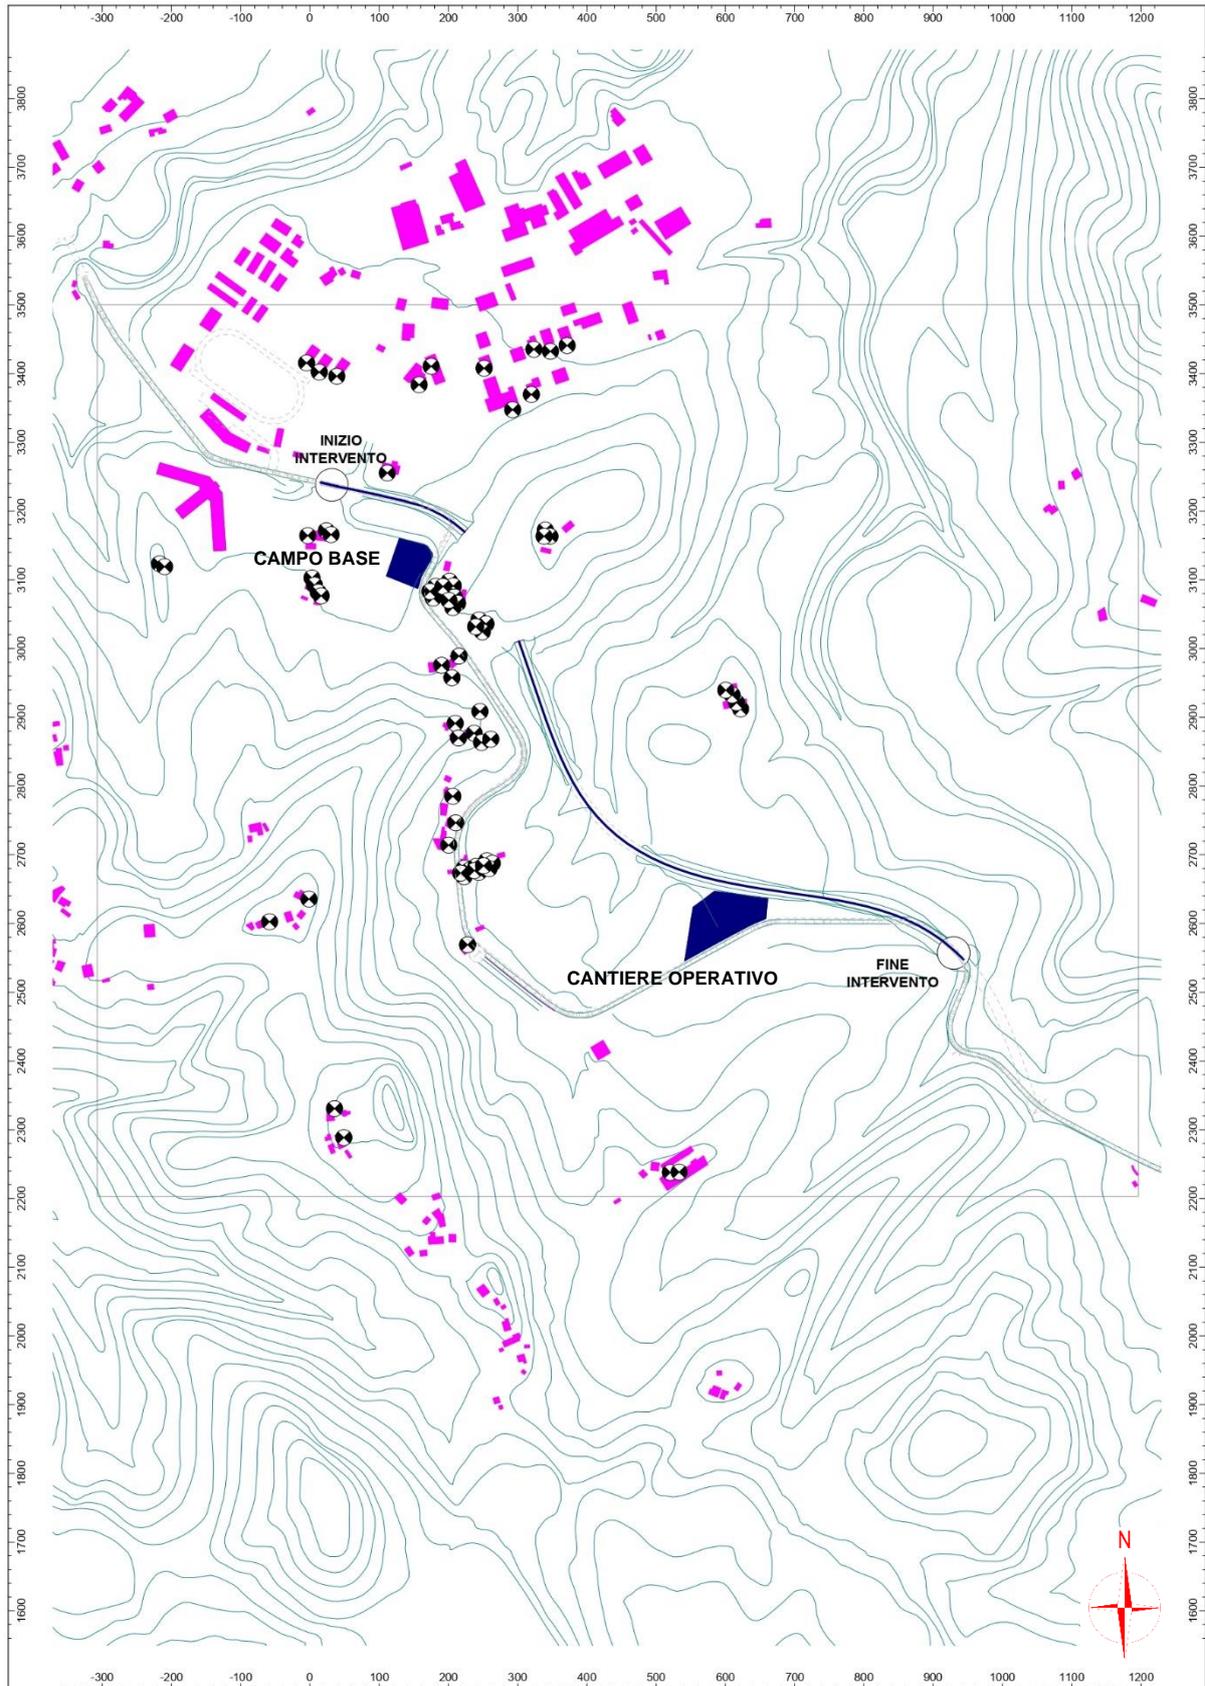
Modello di simulazione (planimetria) – scenario di cantiere
